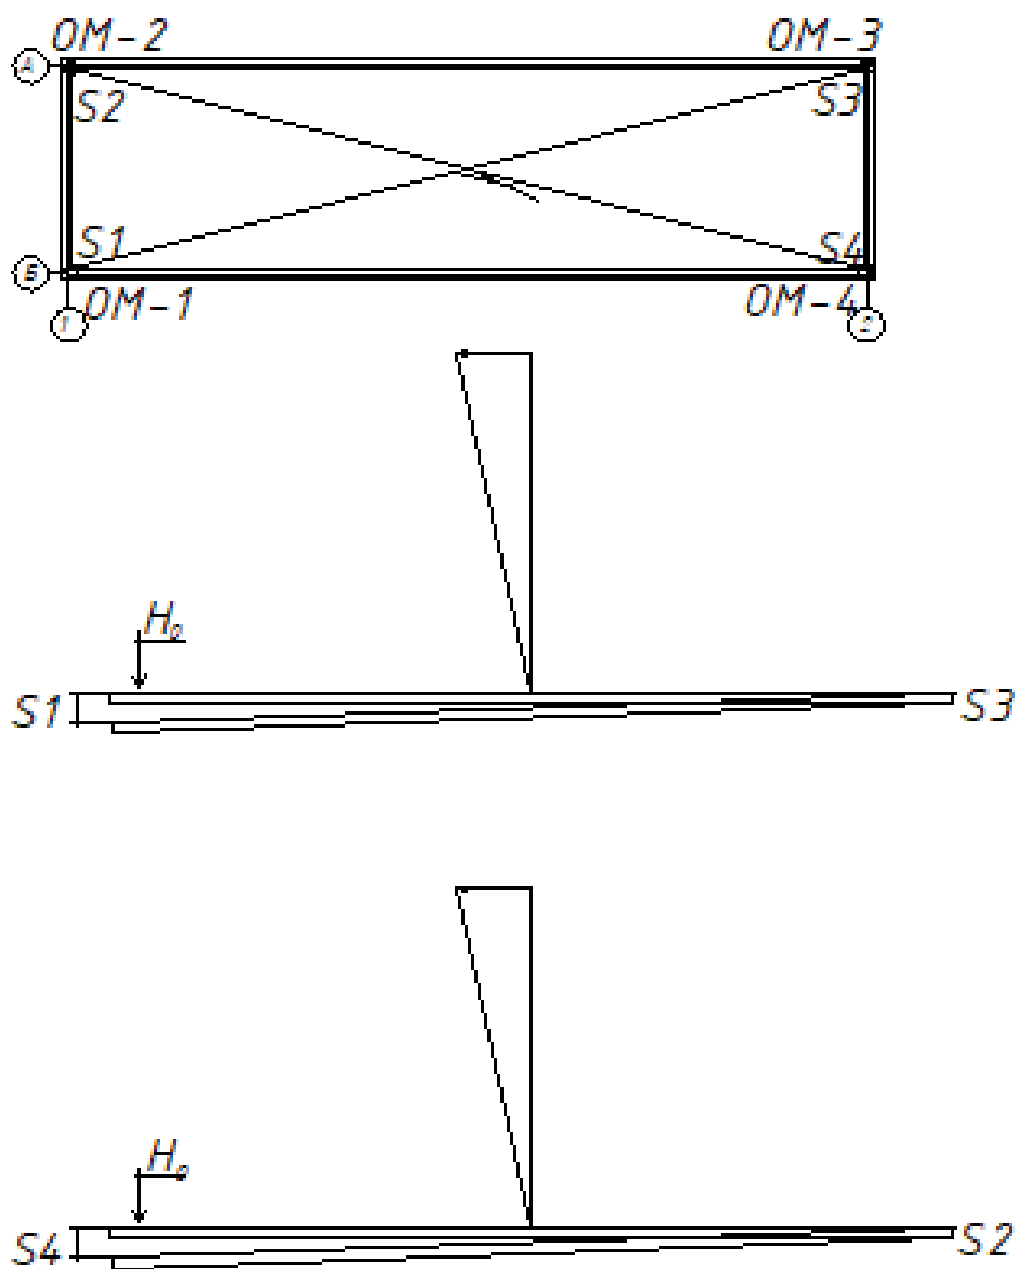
Определение величины и направления крена здания головкой (плитные осадочные марки, располагают на перекрытиях подземных сооружений, горизонтальных обрезах фундаментов и т.п.).
